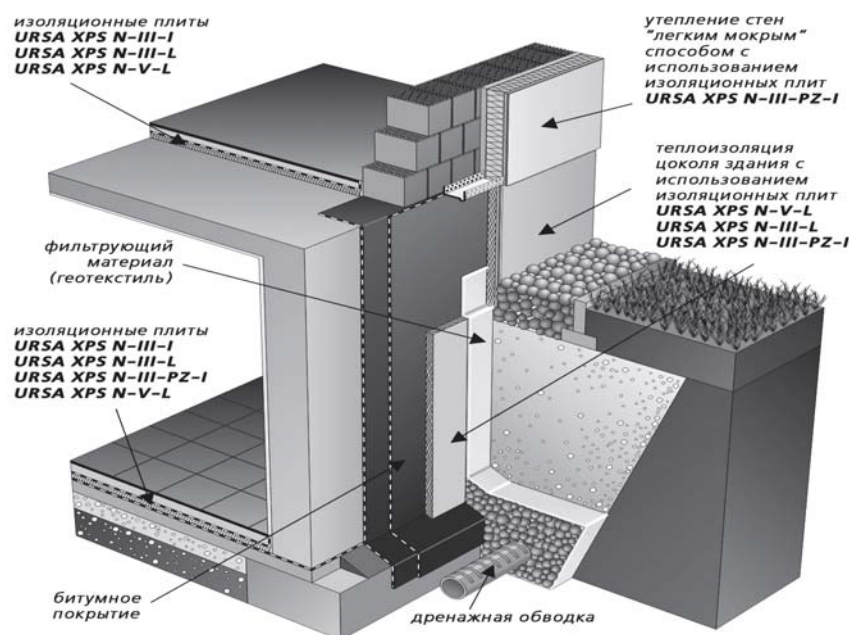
Схемы утепления цокольной и подвальной части здания
